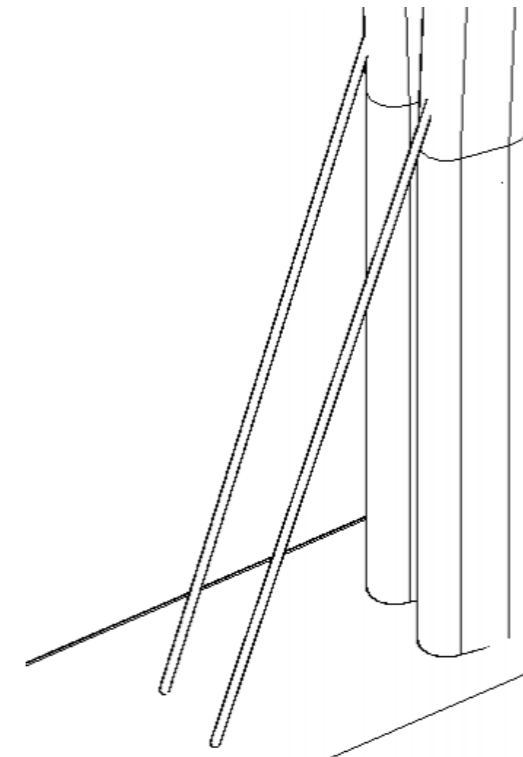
Vista 3D (en estructura alámbrica) de las retenidas de las torres. Fuente: Elaboración Propia (AutoCAD)
